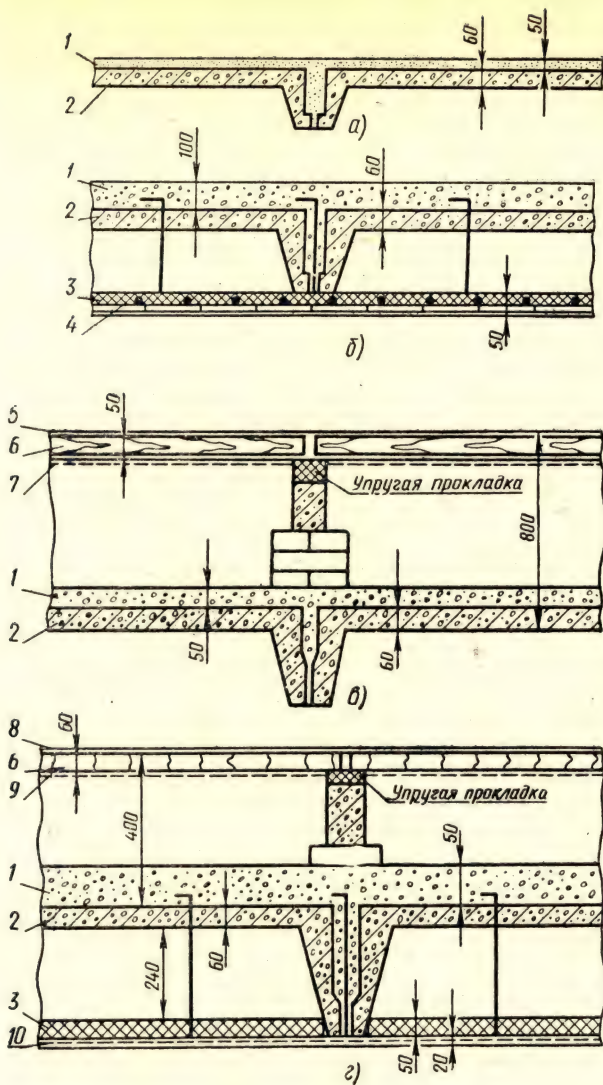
Схемы перекрытий повышенной звукоизоляции:
